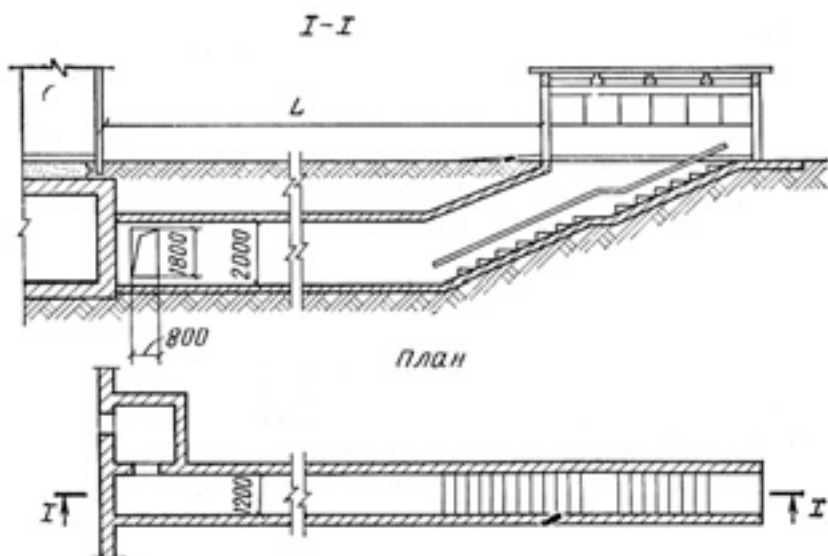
Аварийный выход, совмещенный с входом: L – расстояние от здания до павильона входа, равное высоте здания
